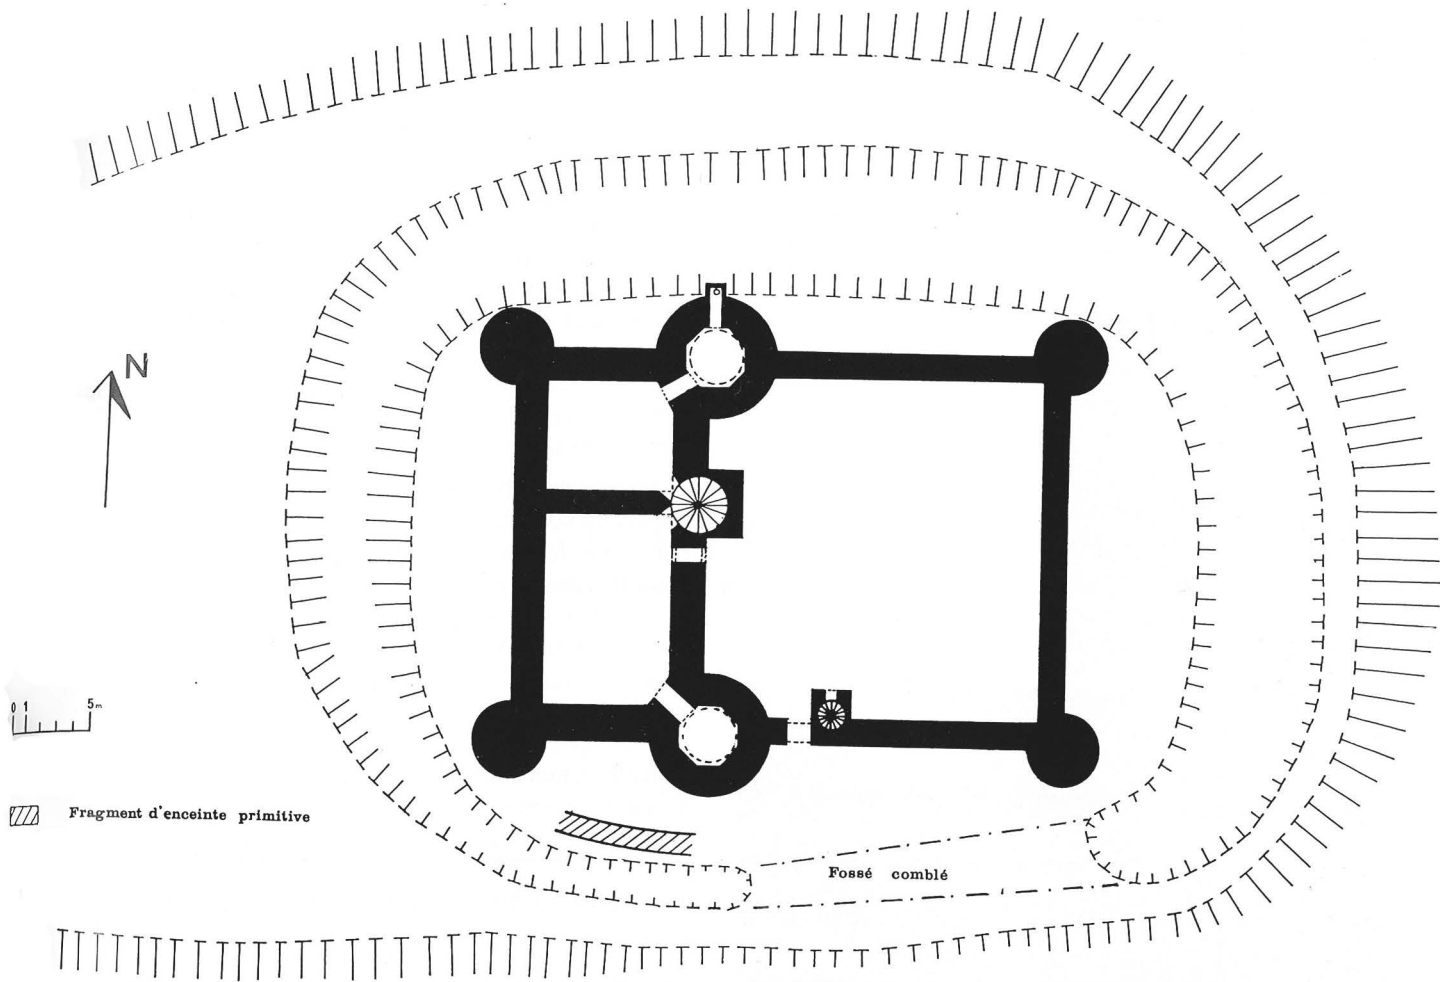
Montaigut-le-Blanc : plan typique des châteaux à donjon-logis de Haute-Marche.
